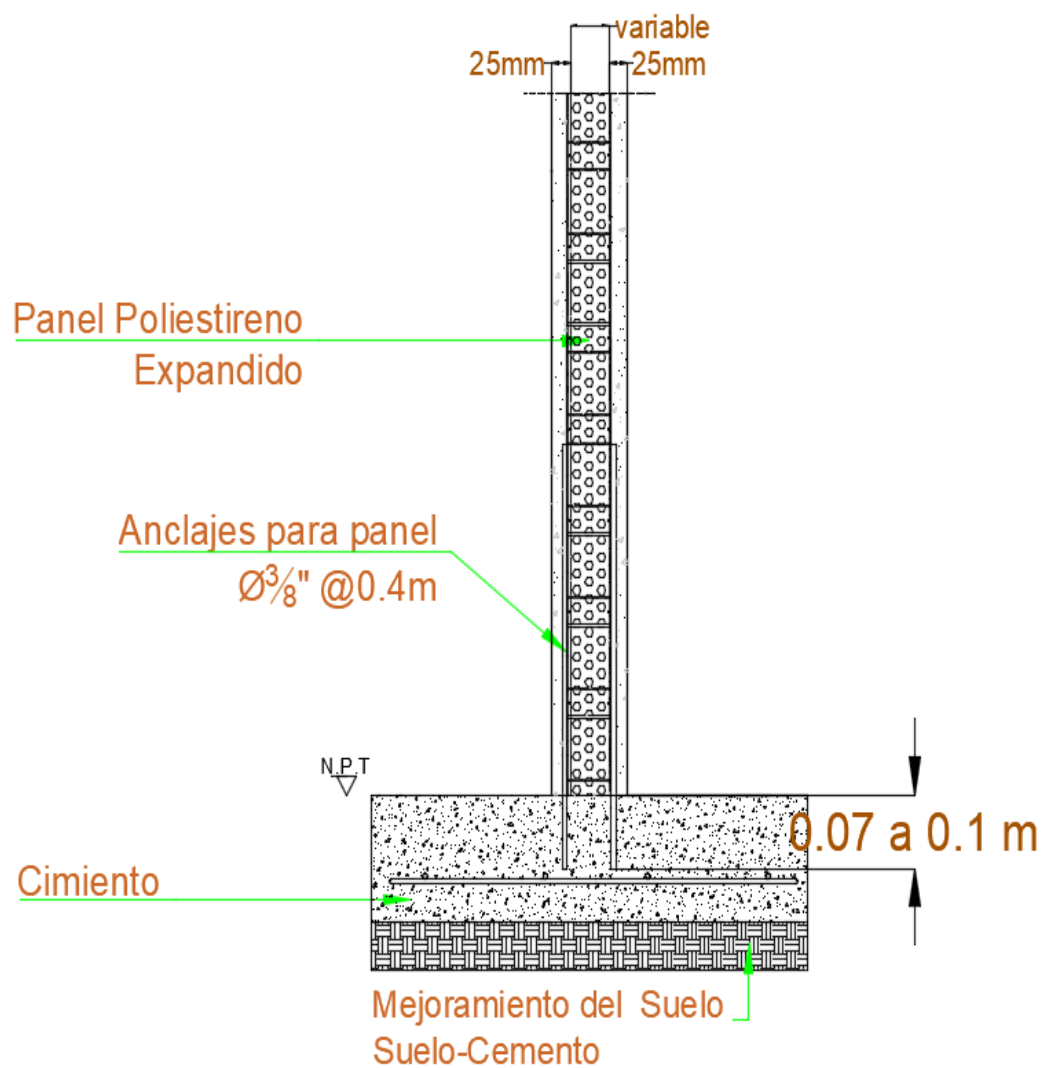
Detalle unión panel de paredes a cimentación (ELEVACIÓN)
